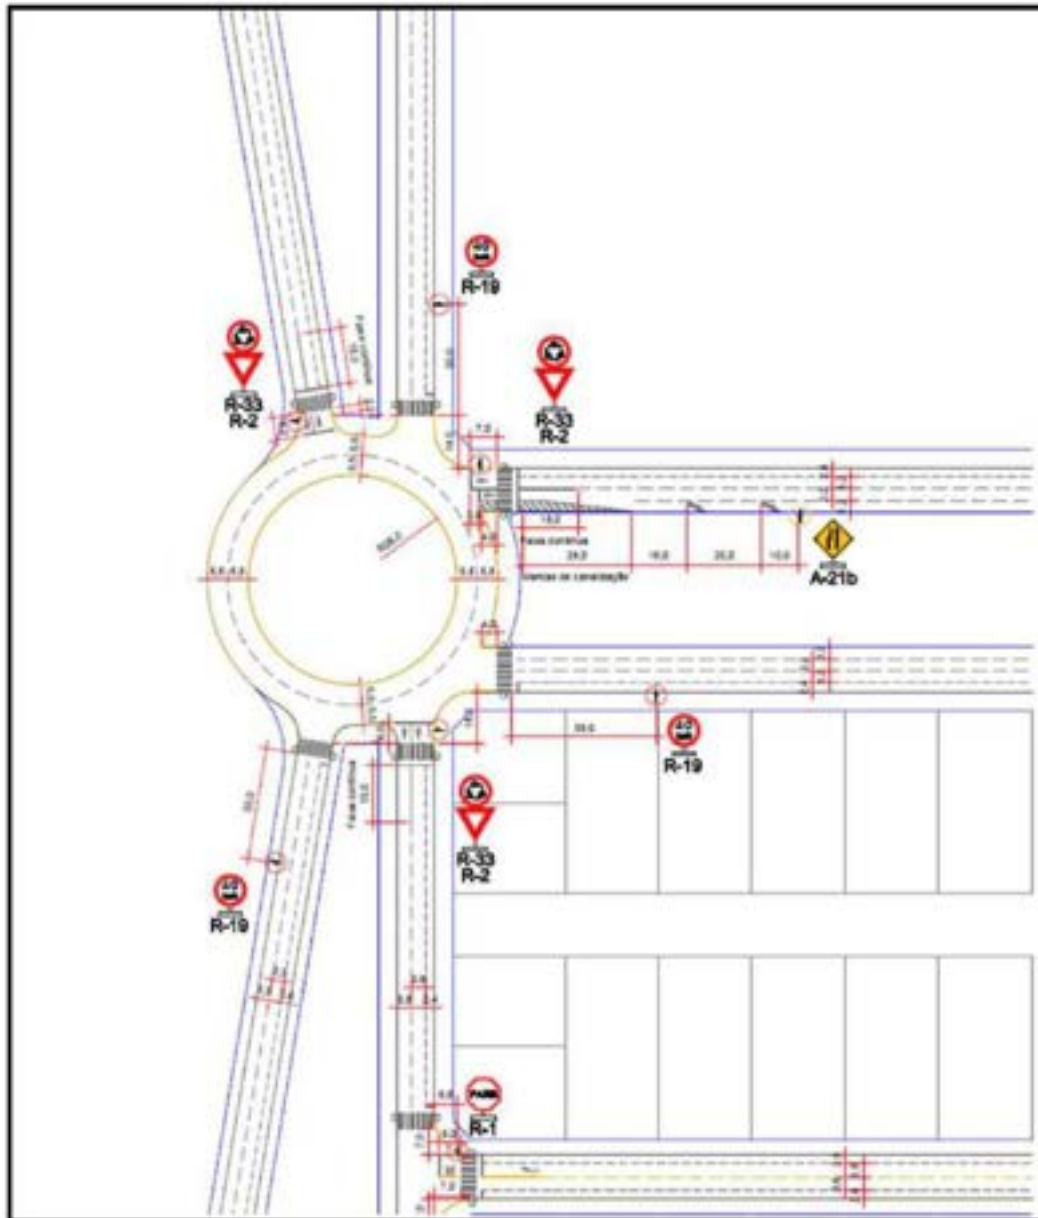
Rotatória prevista para a intersecção interna entre a Rua Alexander Fleming e Boulevard Peter Drucker Leste.
